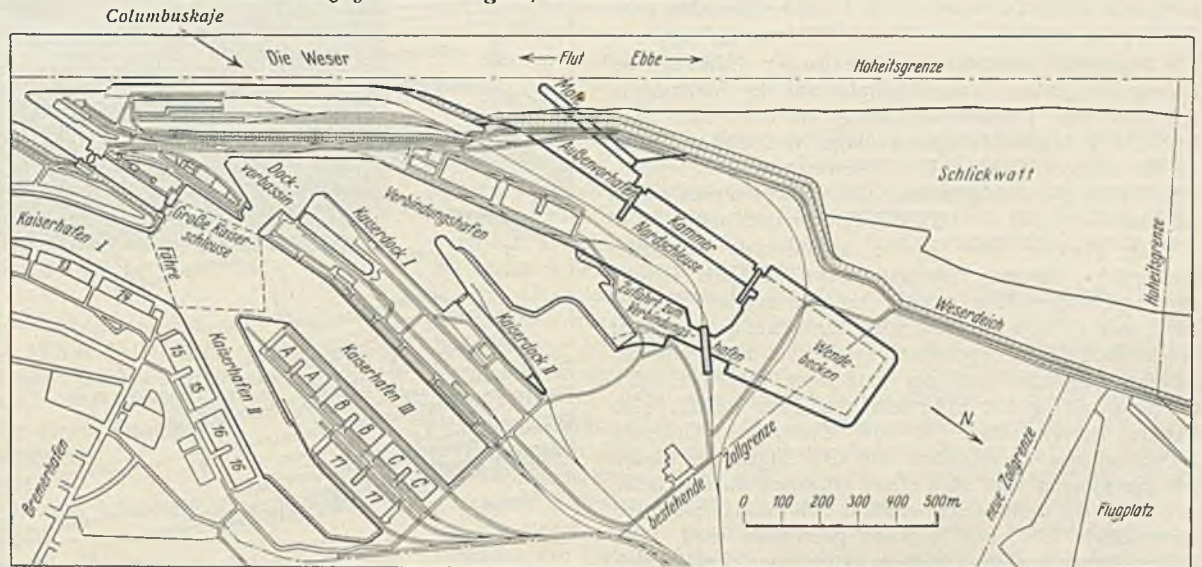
Lageplan der Fahrgast- und Nordschleusenanlage.
